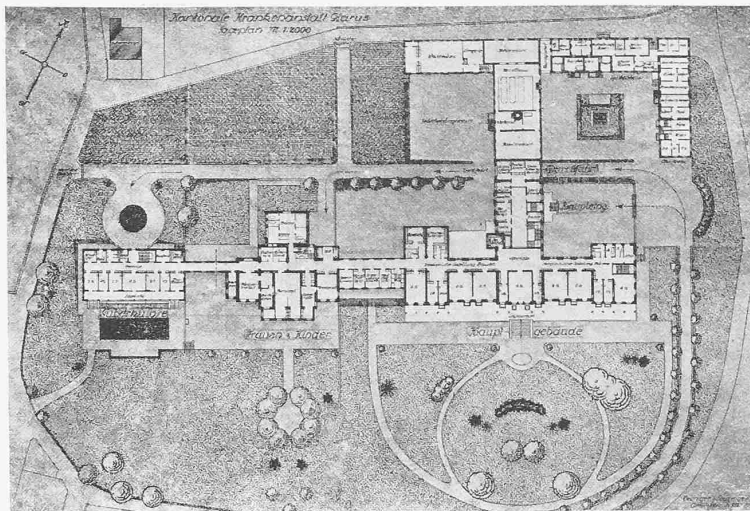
Lageplan des um- und ausgebauten Spitals. — Masstab 1:2000.
